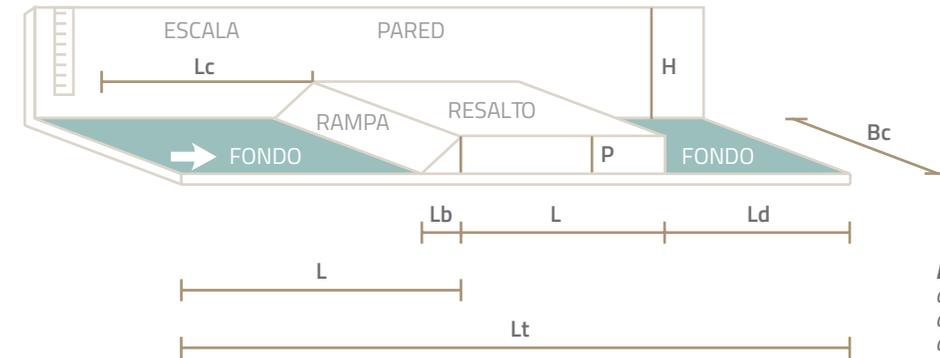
Plano constructivo de aforador cresta ancha tipo.
